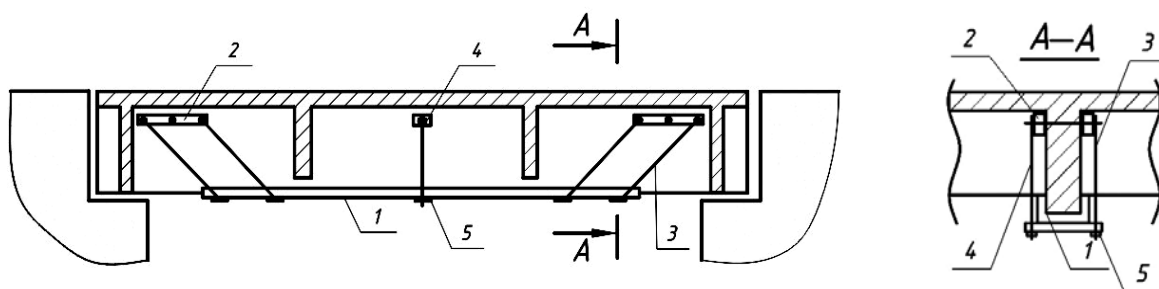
Усиление балок наклеиванием на них металлических элементов эпоксидным клеем: 1 – швеллер усиления; 2 – металлические полосы усиления; 3 – напрягаемые тяги; 4 – болты крепления; 5 – гайки регулирования напряжения в тягах (прижатия швеллера)
